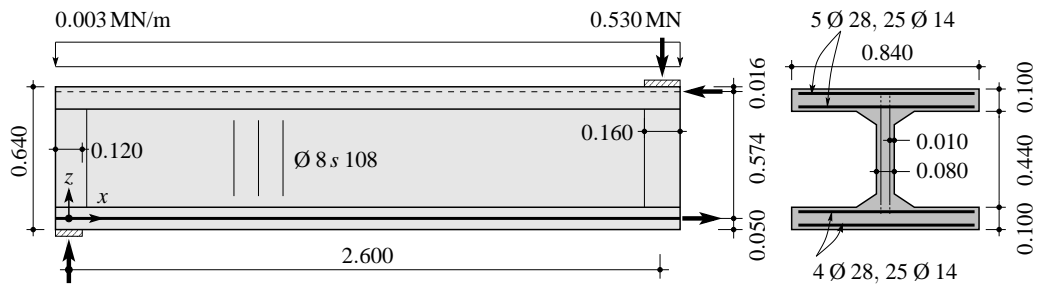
Abmessungen, Bewehrung und Bruchlast des Versuchsträgers StbIII von Reineck et al. [130]
